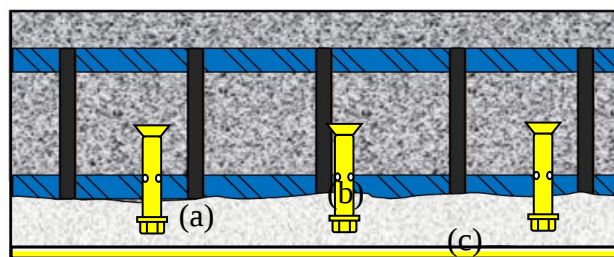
Kegagalan lekatan beton lama dengan Grouting (a) Beton (b) Tulangan (c) Grouting (d) GFRP
